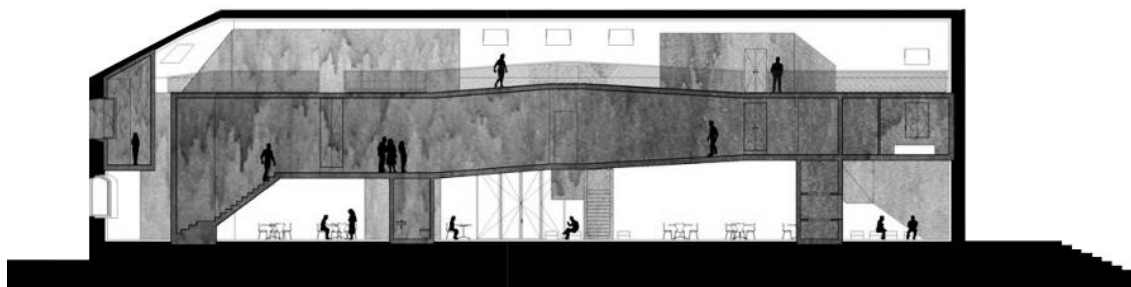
Corte longitudinal do edifício da Casa dos Cubos
